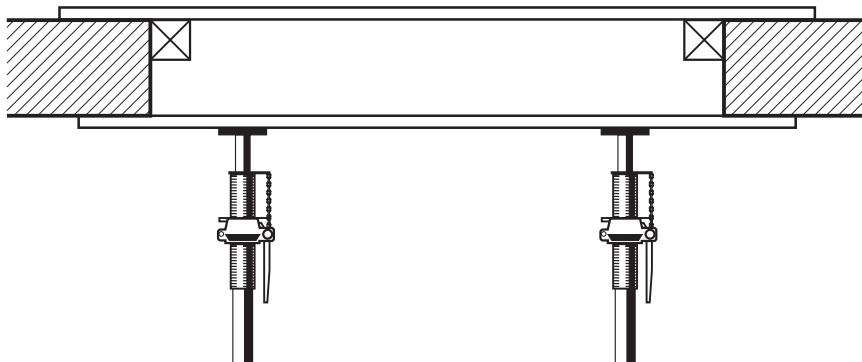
Перекрытие вырезов в полу и в потолке
